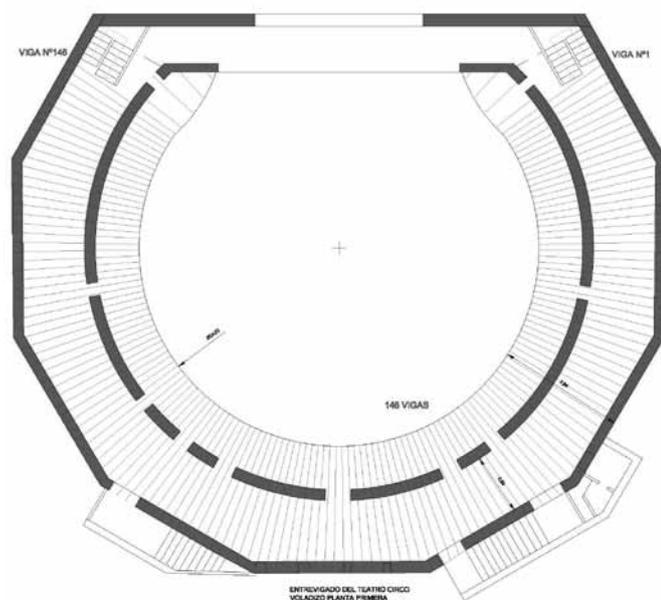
Planta Teatro Circo, muros carga y entrevigado primer anfiteatro.
